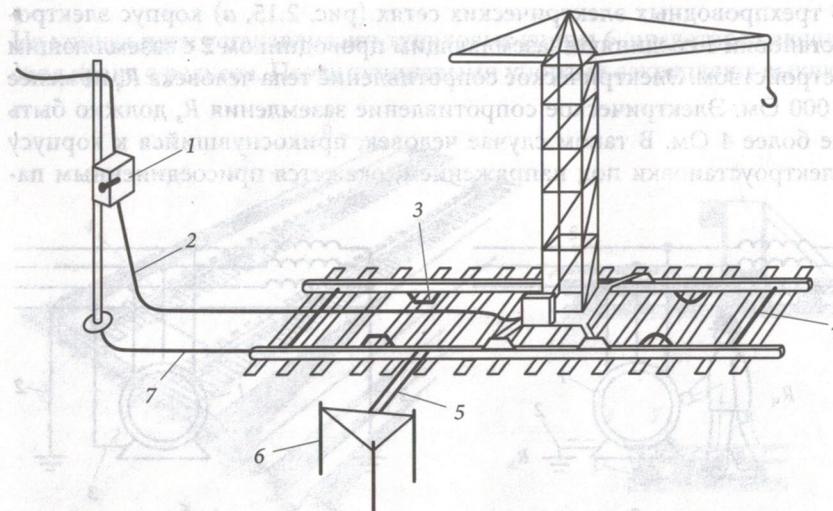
Защитное заземление крана: 1 — рубильник; 2 — кабель; 3, 4 — перемычки; 5, 7 — проводники; 6 — заземлитель
